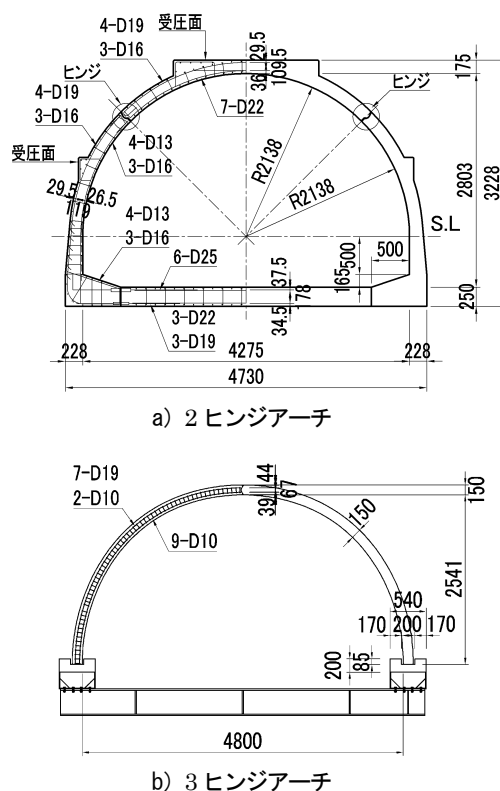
実験供試体の構造配筋図 (単位:mm, 鉄筋本数は奥行方向1mあたり)
